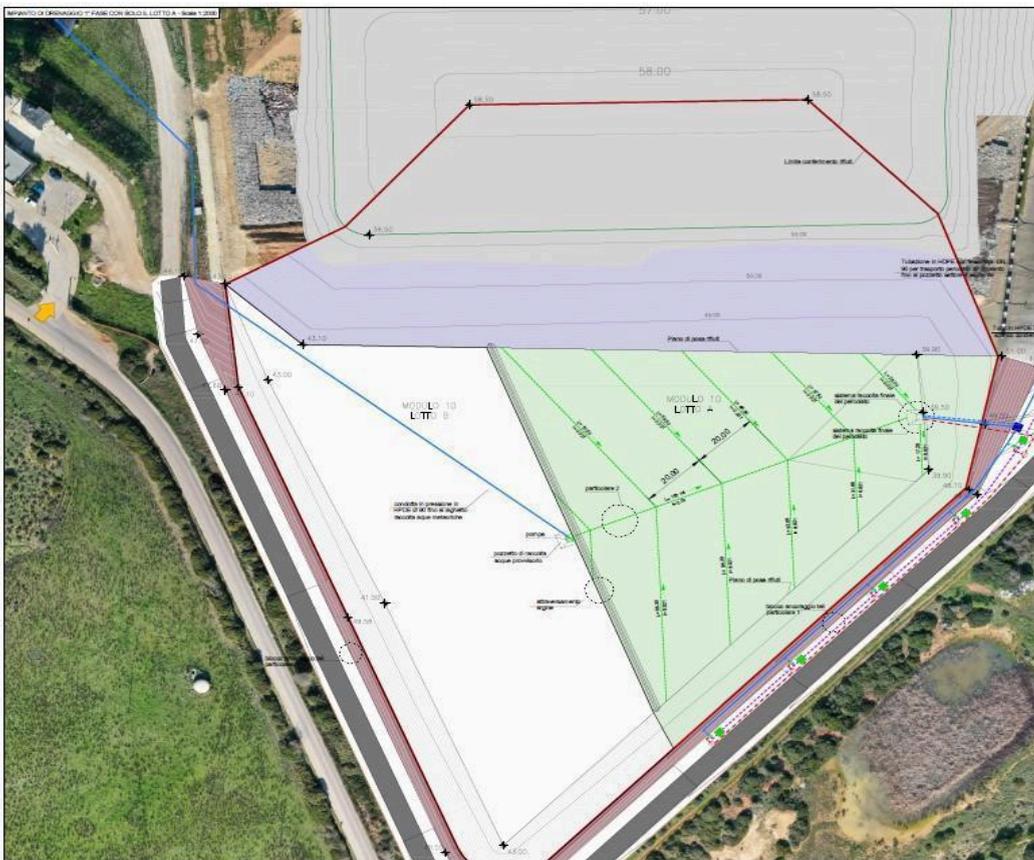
Planimetria nuovo Modulo 10 e suddivisione in lotto A e Lotto B
